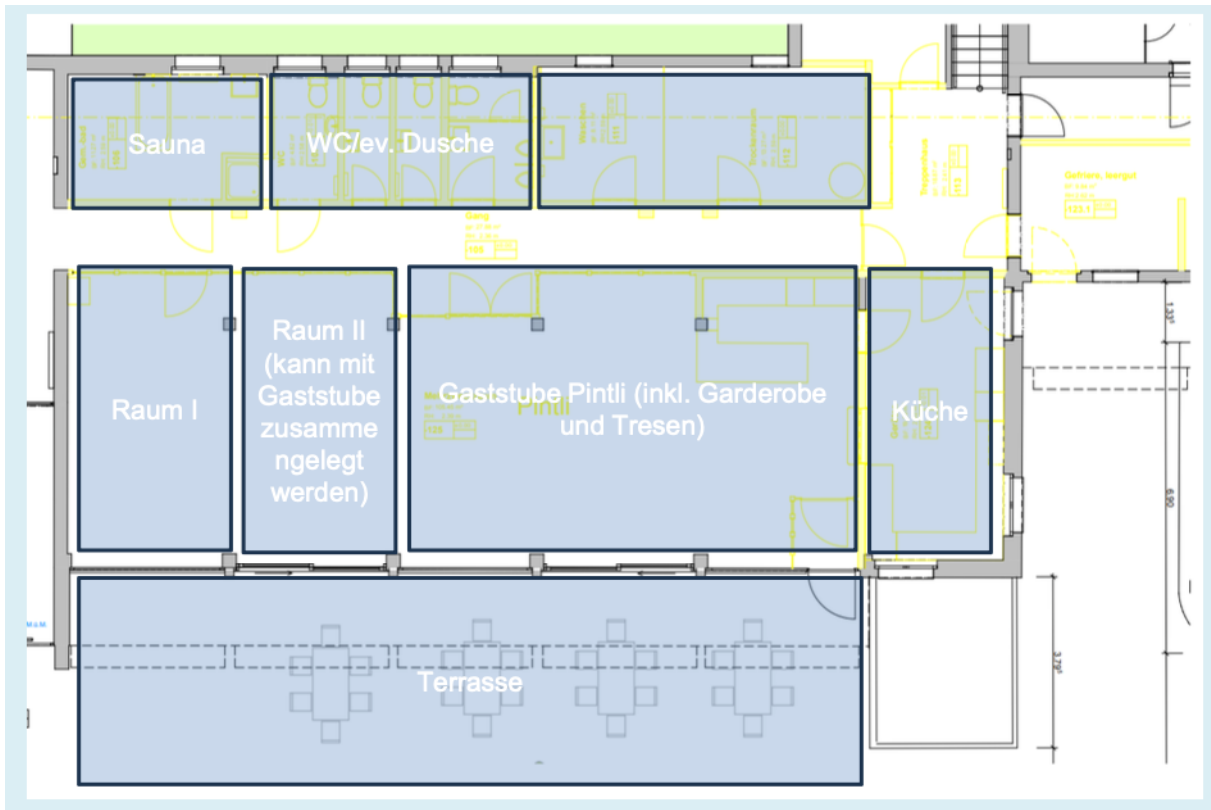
Grundrissplan Haus 8 EG – eine mögliche Variante (aus Workshop von David Fässler 19.01.2026)
